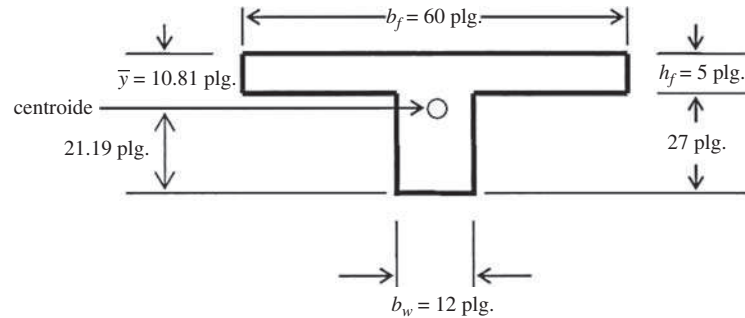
Sección transversal de la viga del Ejemplo 2.1.
